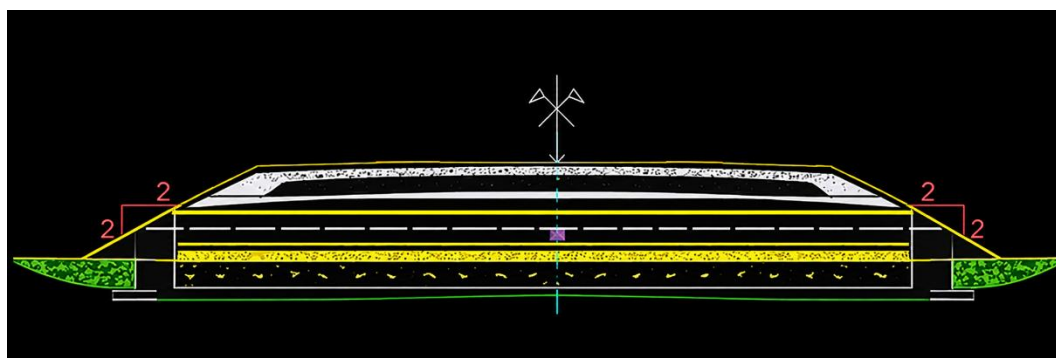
10 - Rapproche détails du Profil en travers types ouvrage hydraulique
